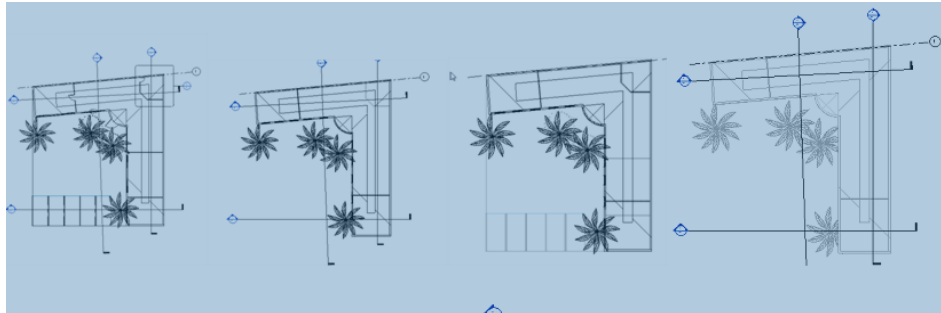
Plantas arquitectónicas y de azotea de los niveles 1, 2, 3, y 4
